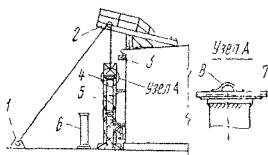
Схема монтажа вертикальных воздухопроводов по наружным стенам здания методом наращивания снизу
